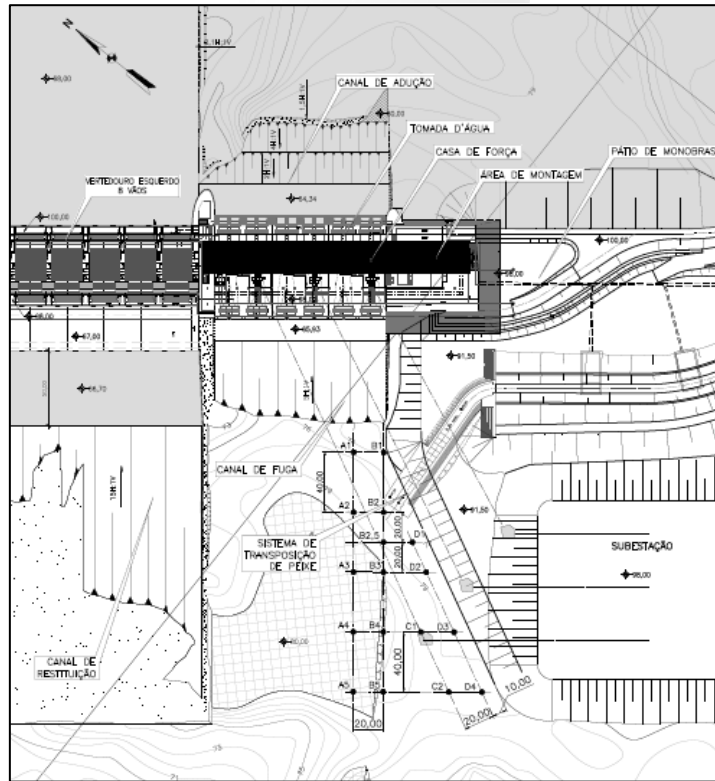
7 – Arranjo em planta da Alternativa Final para dique junto à entrada do STP (Anexo 2, LEME (2012)).
